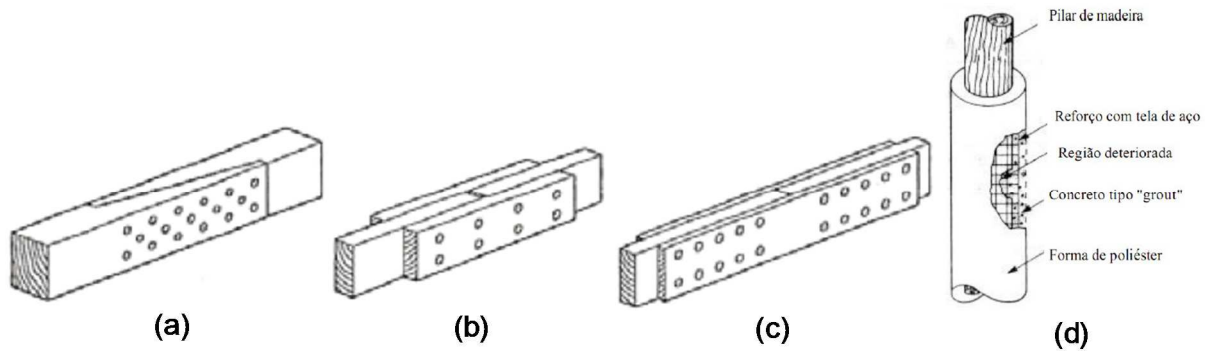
Ligação tipo bisel (a); Reforço por peças de madeira parafusadas (b); Reforço por chapas metálicas parafusadas (c); Encamisamento em concreto (d)
